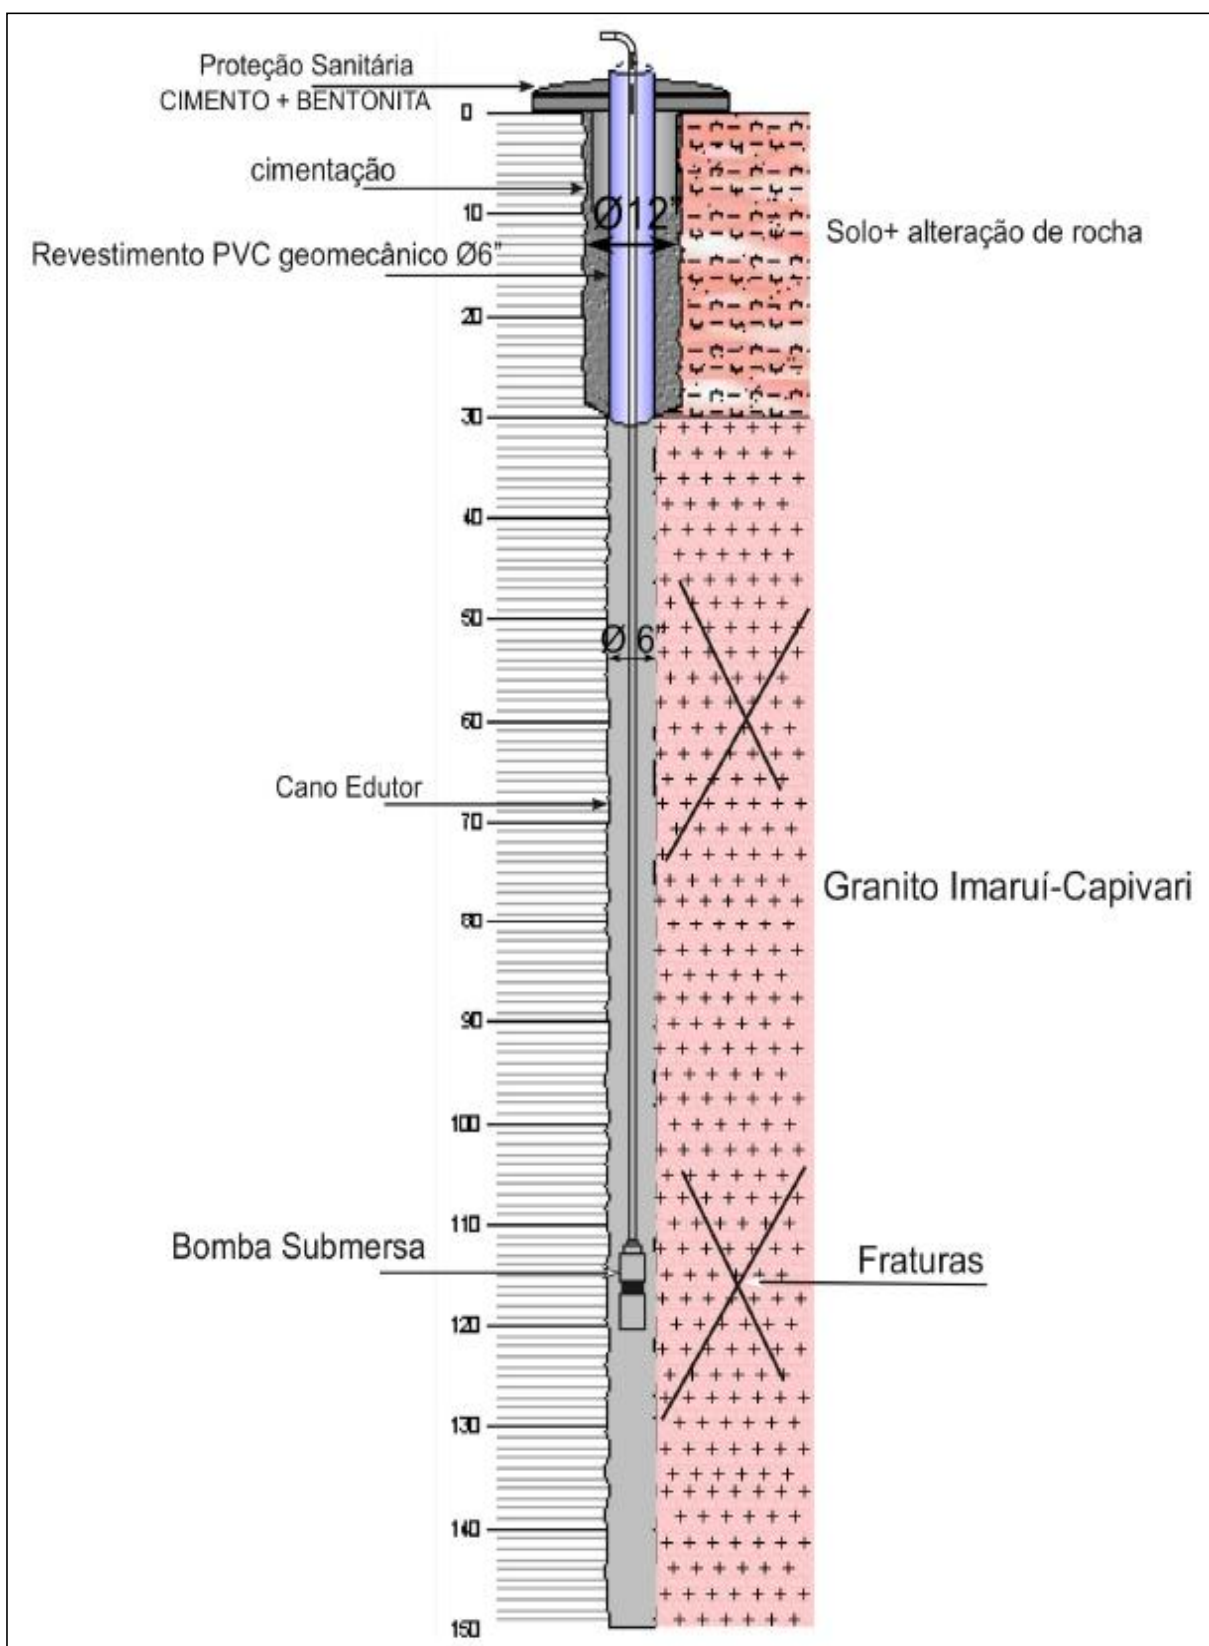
Projeto de Poço Tubular sugerido para as áreas de Rio Pinheiro e Santa Clara.
